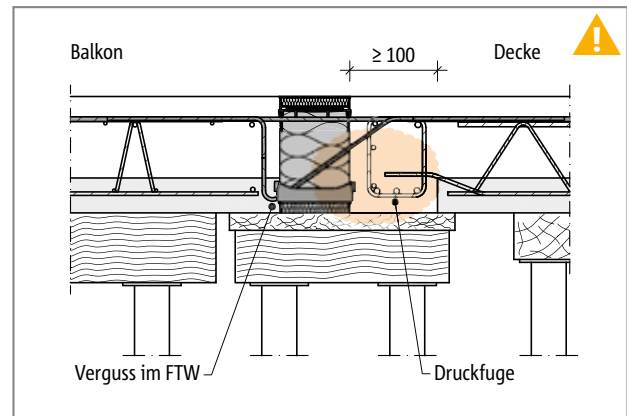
Schöck Isokorb® XT Typ K: Indirekte Lagerung, Einbau in Verbindung mit Elementplatten (hier: $h \leq 180$ mm), Druckfuge deckenseitig
